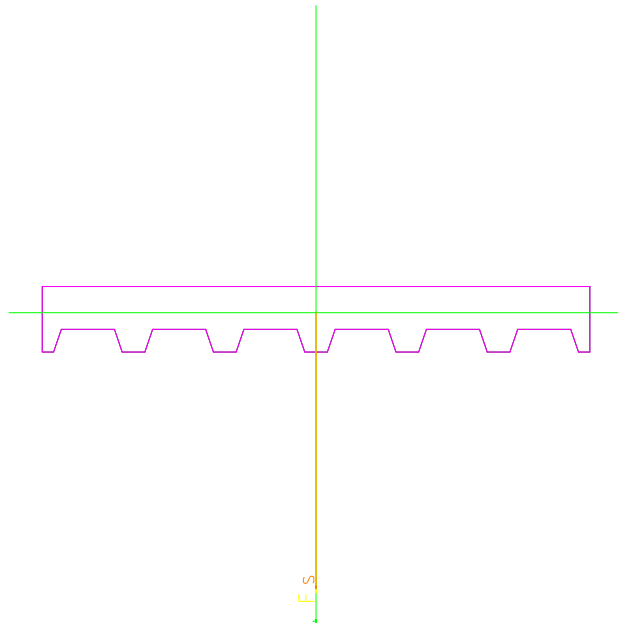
Cálculo de área e inercia en AutoCAD (concreto)
